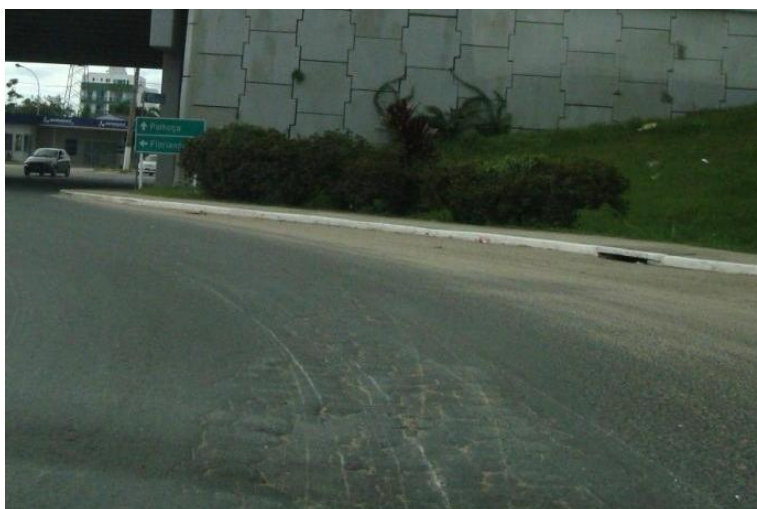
Trincas interligadas no pavimento da interseção de Palhoça
